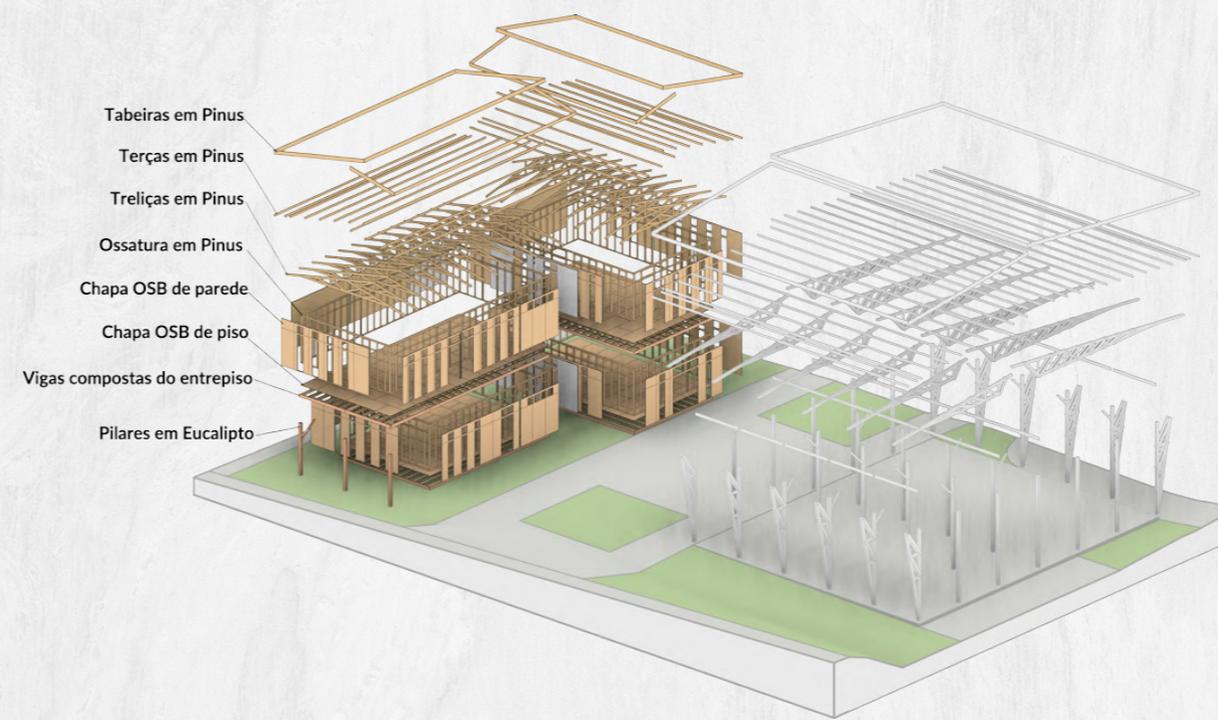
Elementos da estrutura do bloco de wood-frame.
